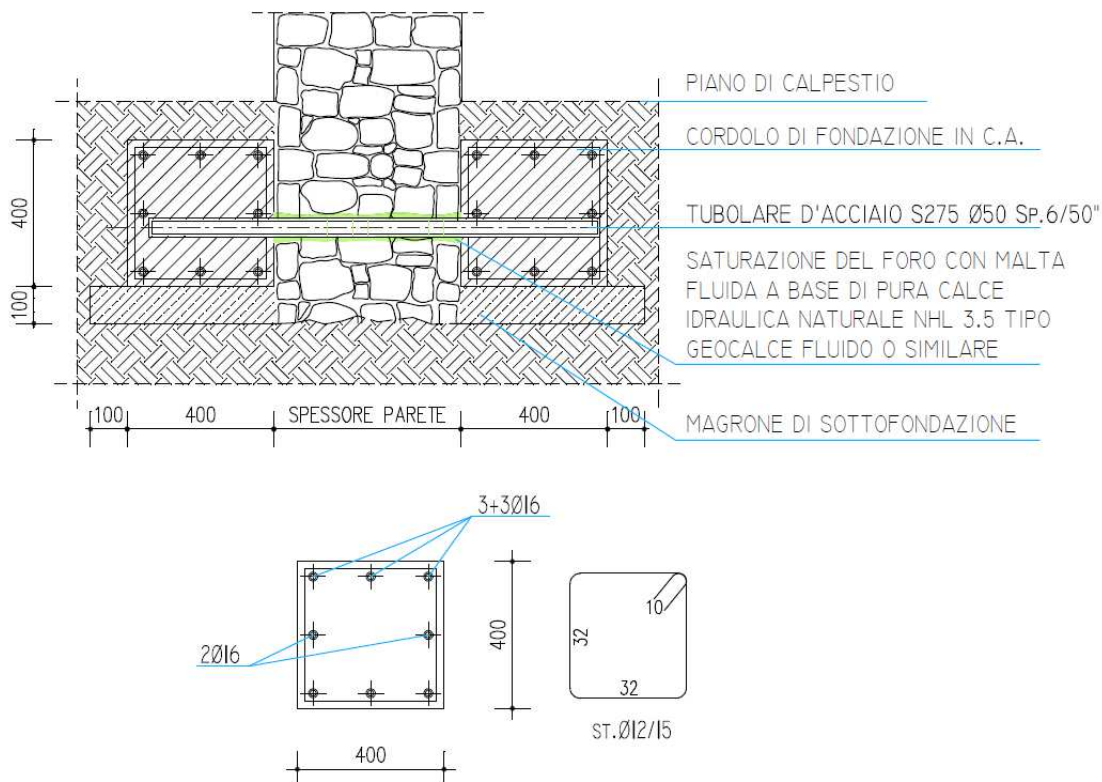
intervento di ringrosso fondazione mediante cordoli in c.a.
